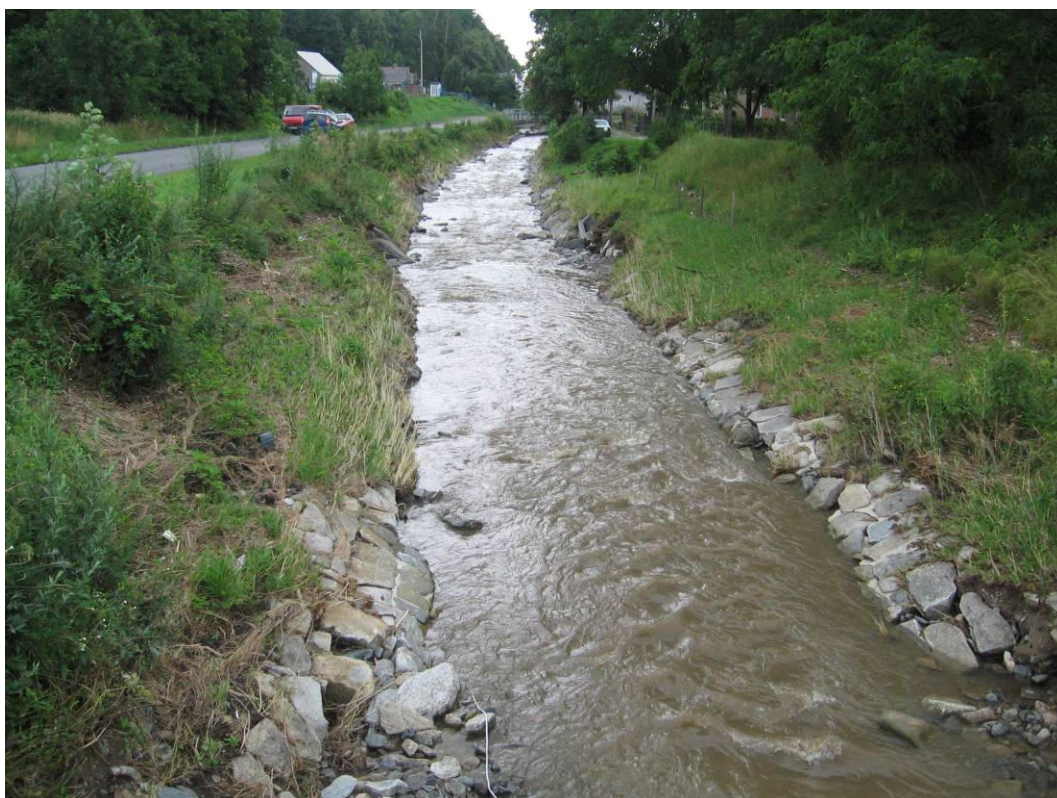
Upravený Javornický potok pod lávkou pro pěší
